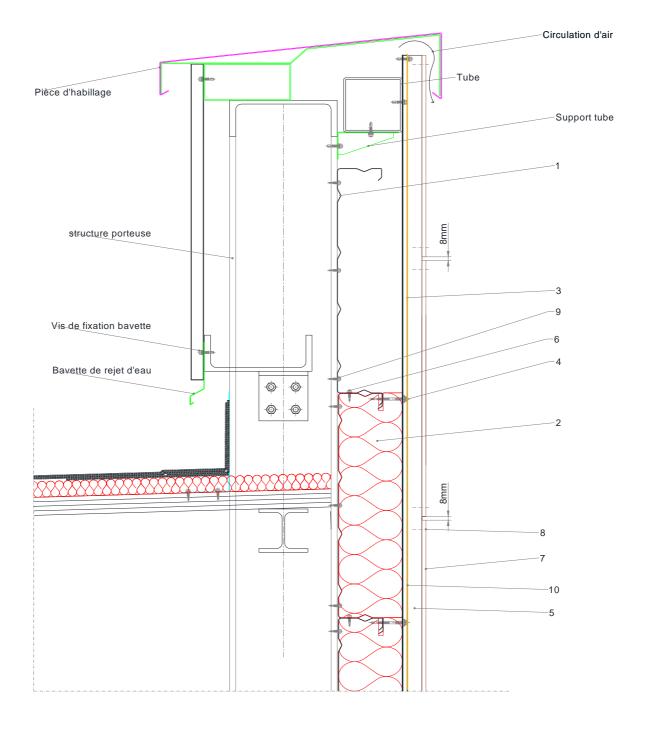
is – Arrêt sur acrotère – Coupe verticale
